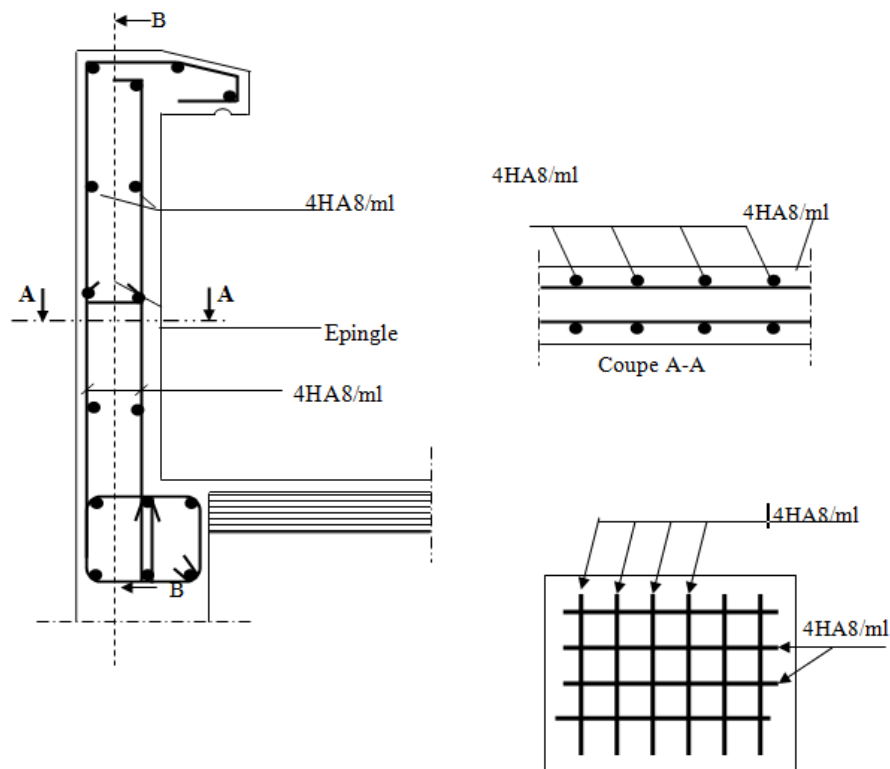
Plan de Ferrailage de l'acrotère.
